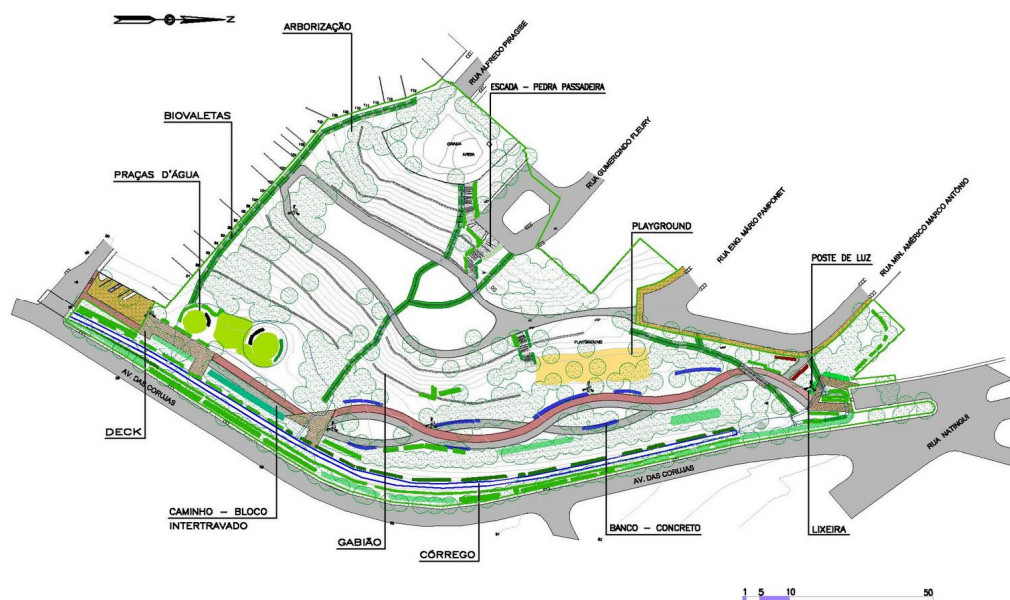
Planta do projeto elaborado pelos arquitetos com participação popular.
